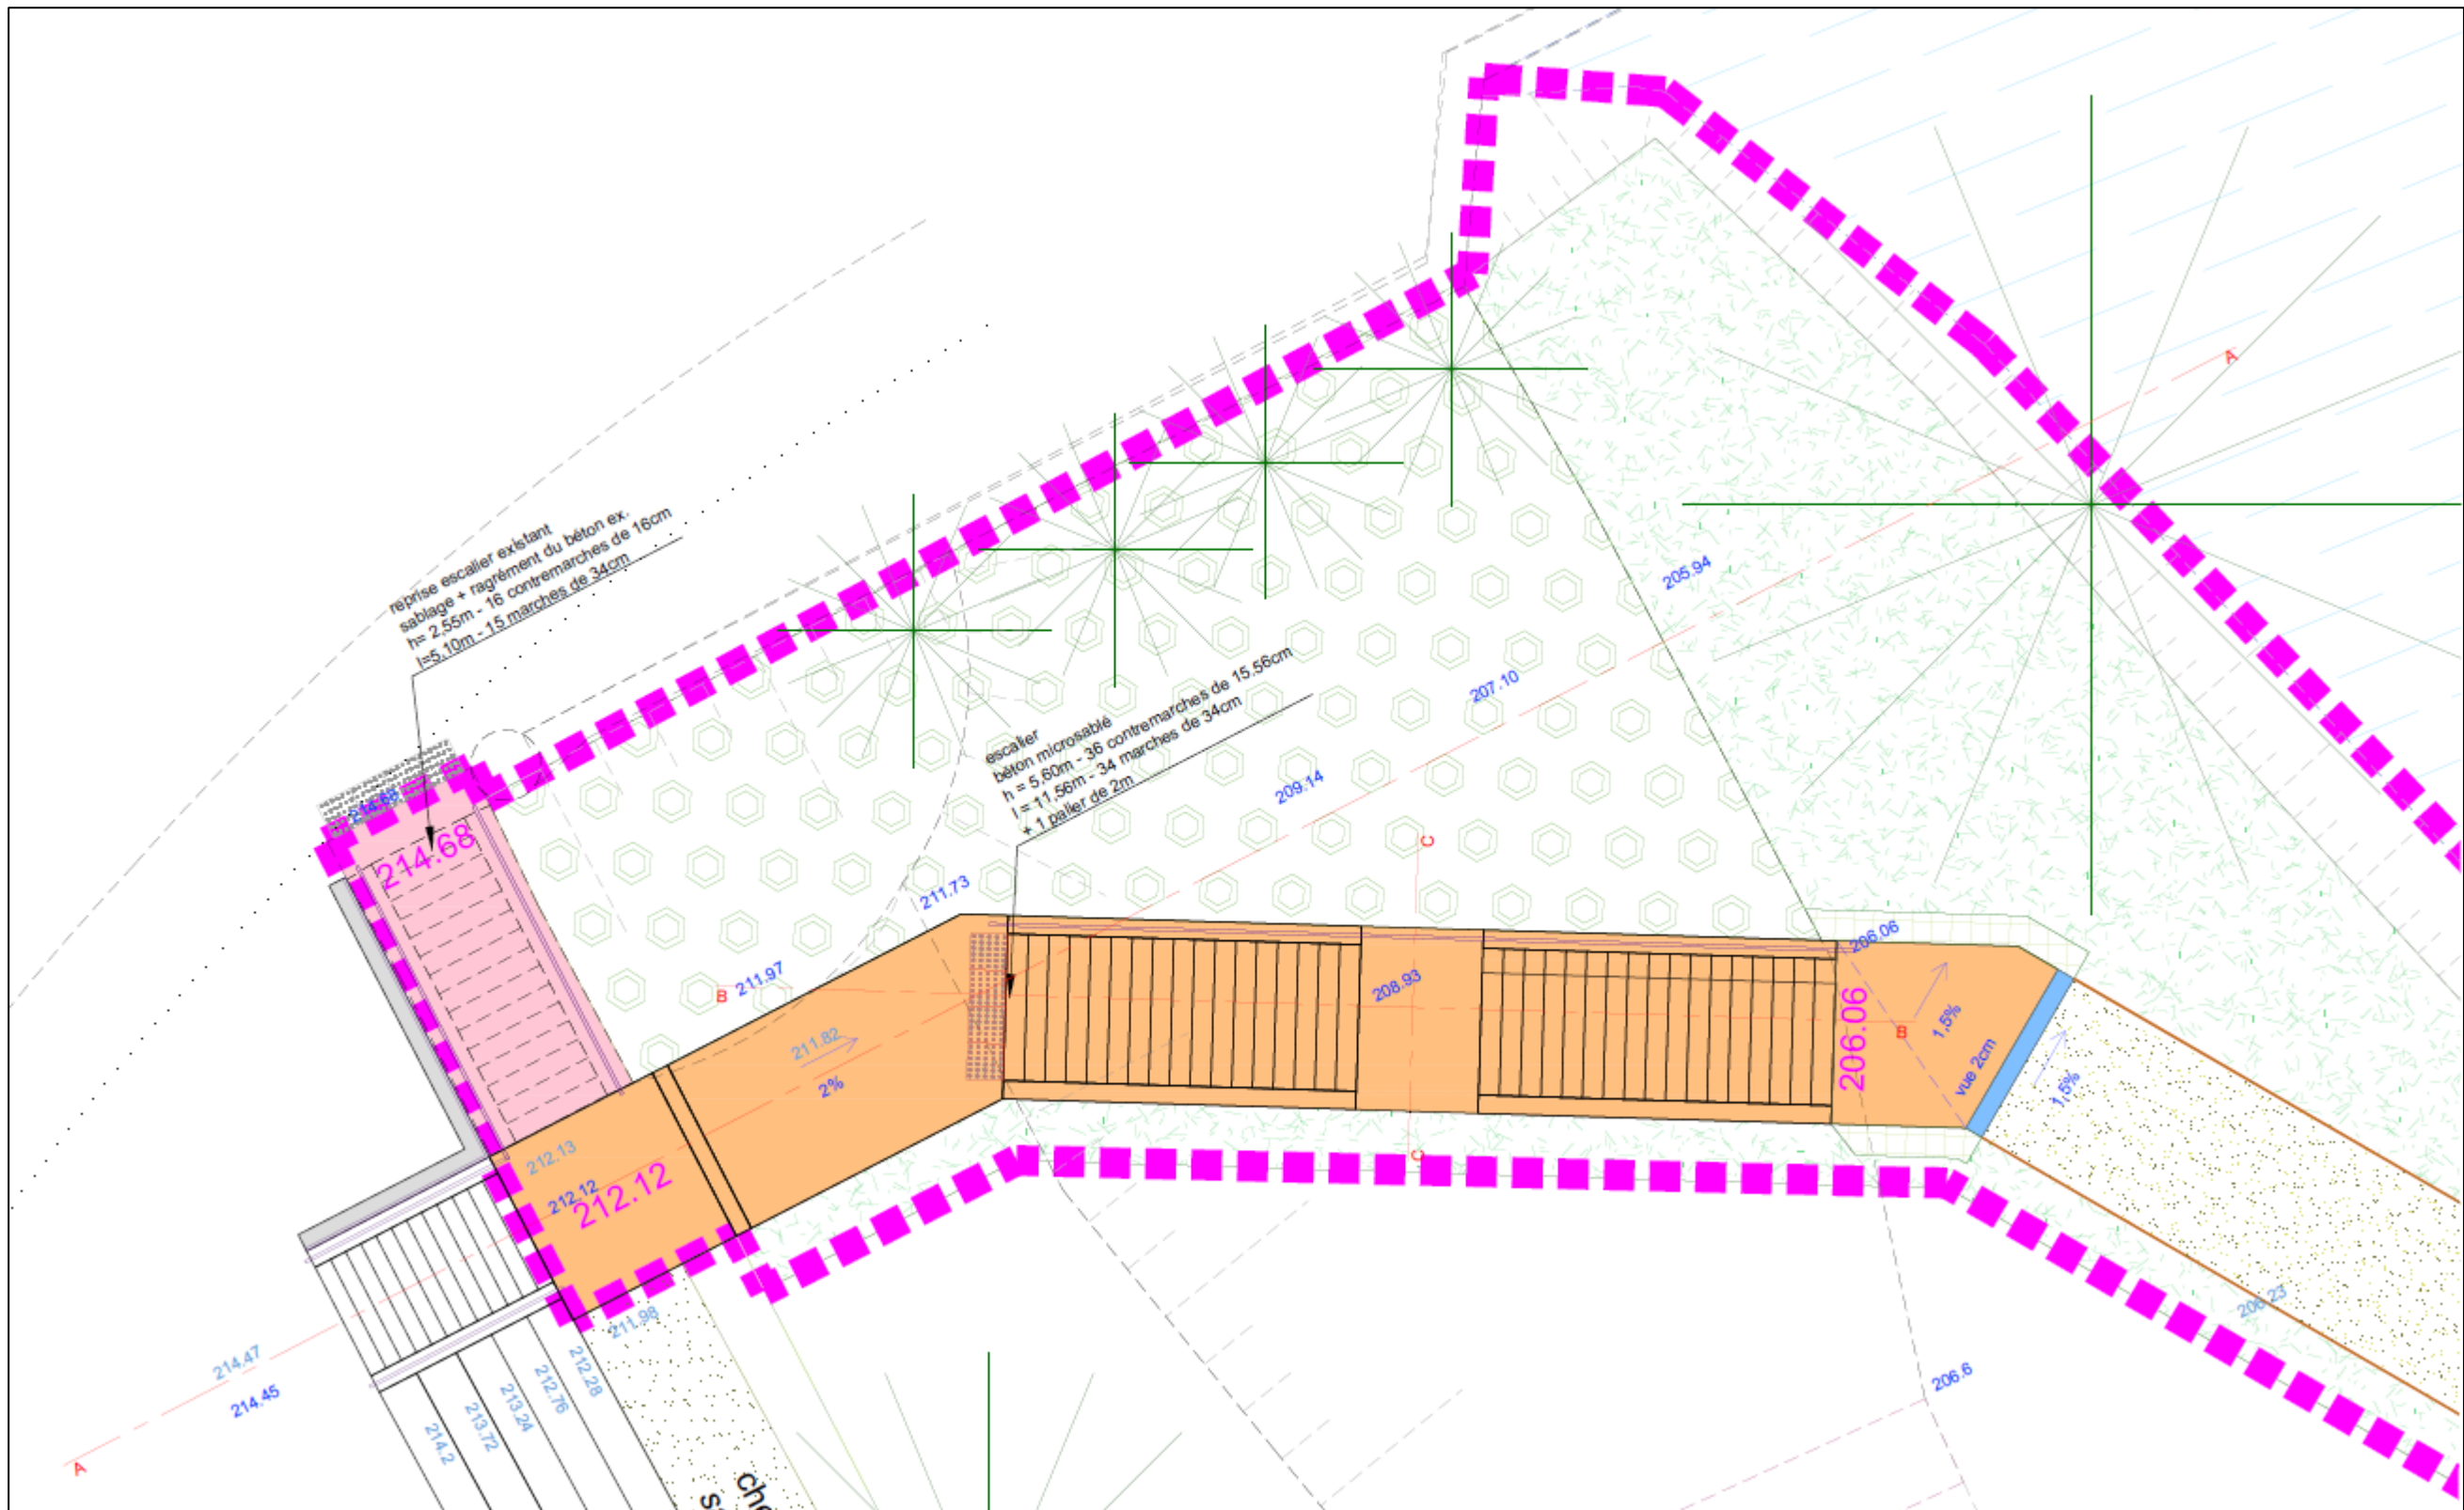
Plan d'implantation de l'escalier Régemortes.
